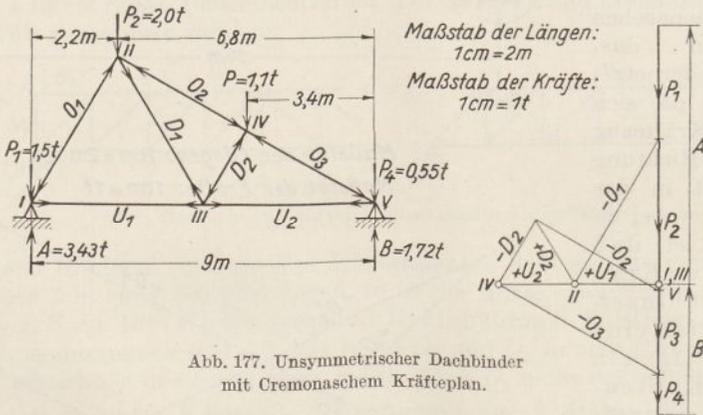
Unsymmetrischer Dachbinder mit Cremonaschem Kräfteplan.
